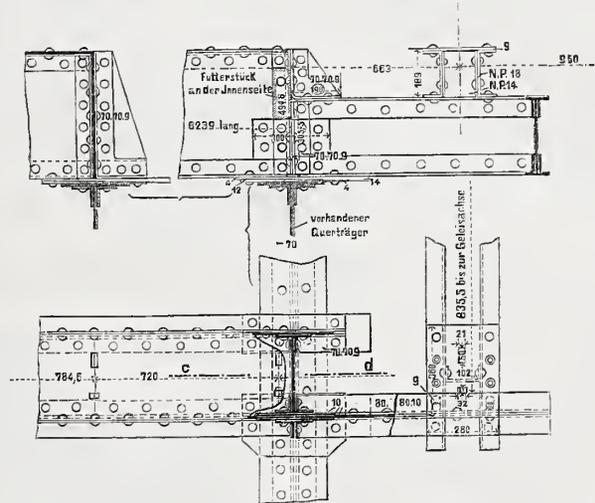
Grundriss. Endigung des Langschwellenbaues und Anschlufs des Querschwellenbaues.
